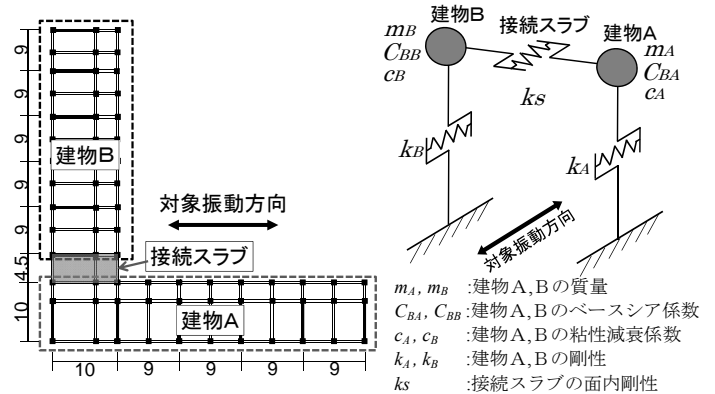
検討対象建物の平面図 (単位:m) 図-2 2 質点モデル
